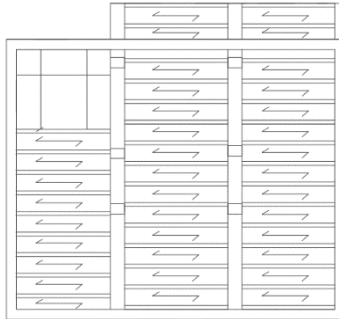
Planta de estructura entre Planta Baja y Planta Primera. Fuente: CAD propio
